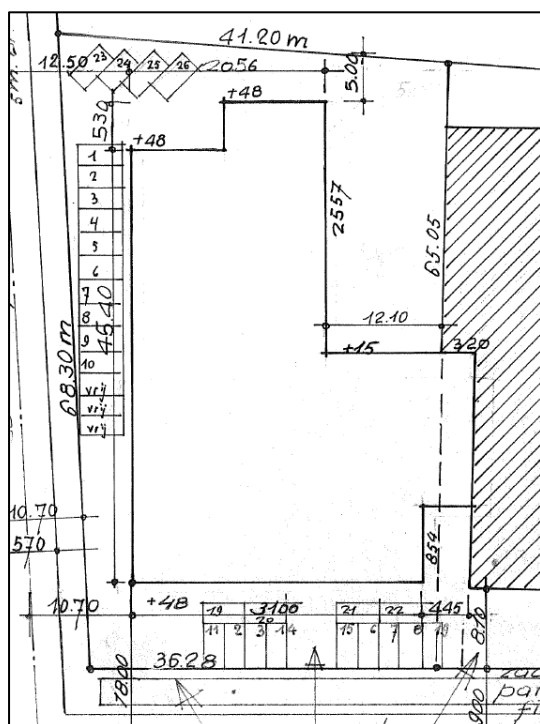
inplantingsplan en buitenaanleg uitbreiding toonzaal 1979 © ATRIUM architecten
